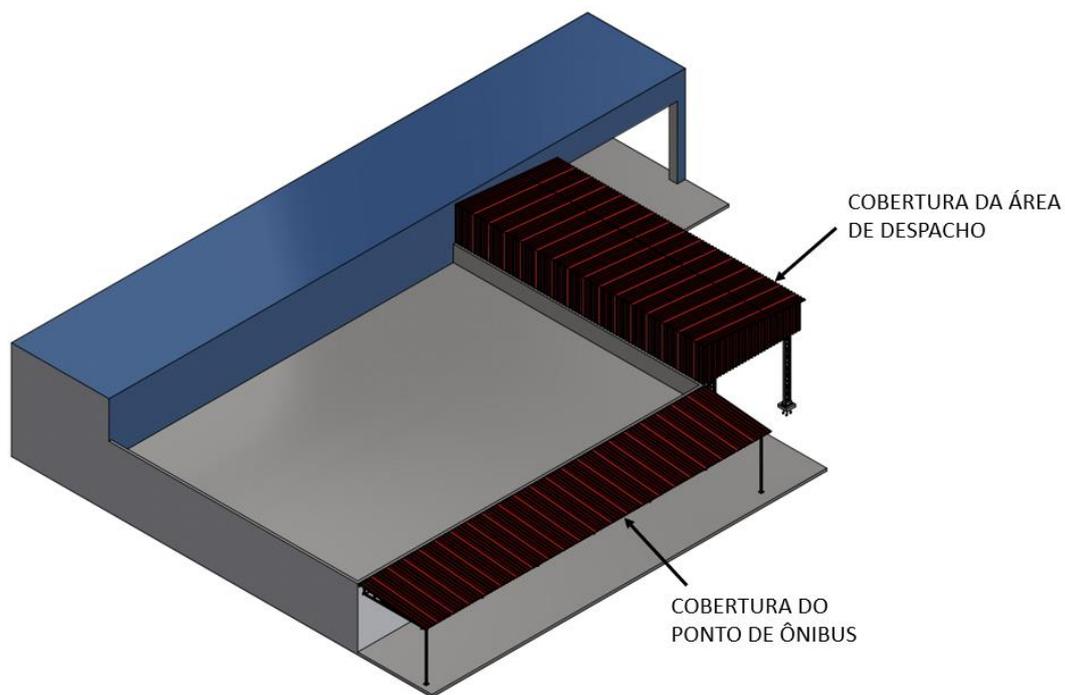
Esquema tridimensional da edificação existente junto das novas coberturas
